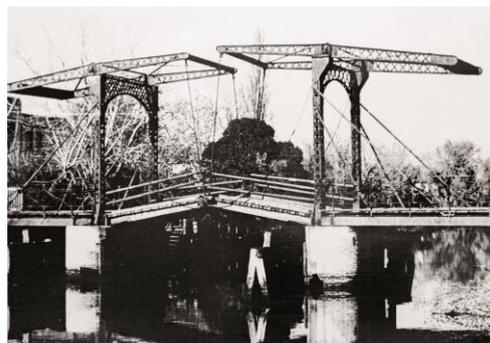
Plano de obra 1885 y Puentes giratorios, levadizos, fijos...
